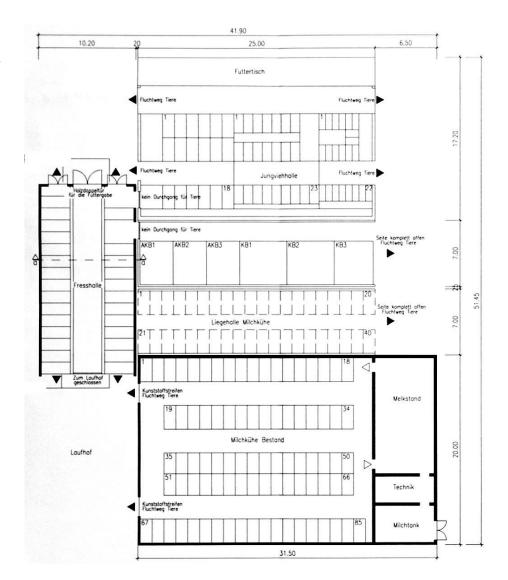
Grundriss der Ställe bis Baujahr 2000, M ca. 1:400
